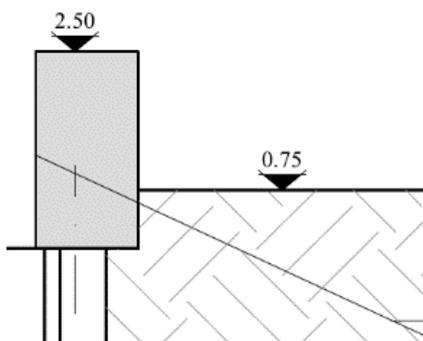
quota trave +2,50 m l.m.m. da PD 1114.STR.04B.02 - Stato Attuale Planimetria e Sezioni_Rev.2
